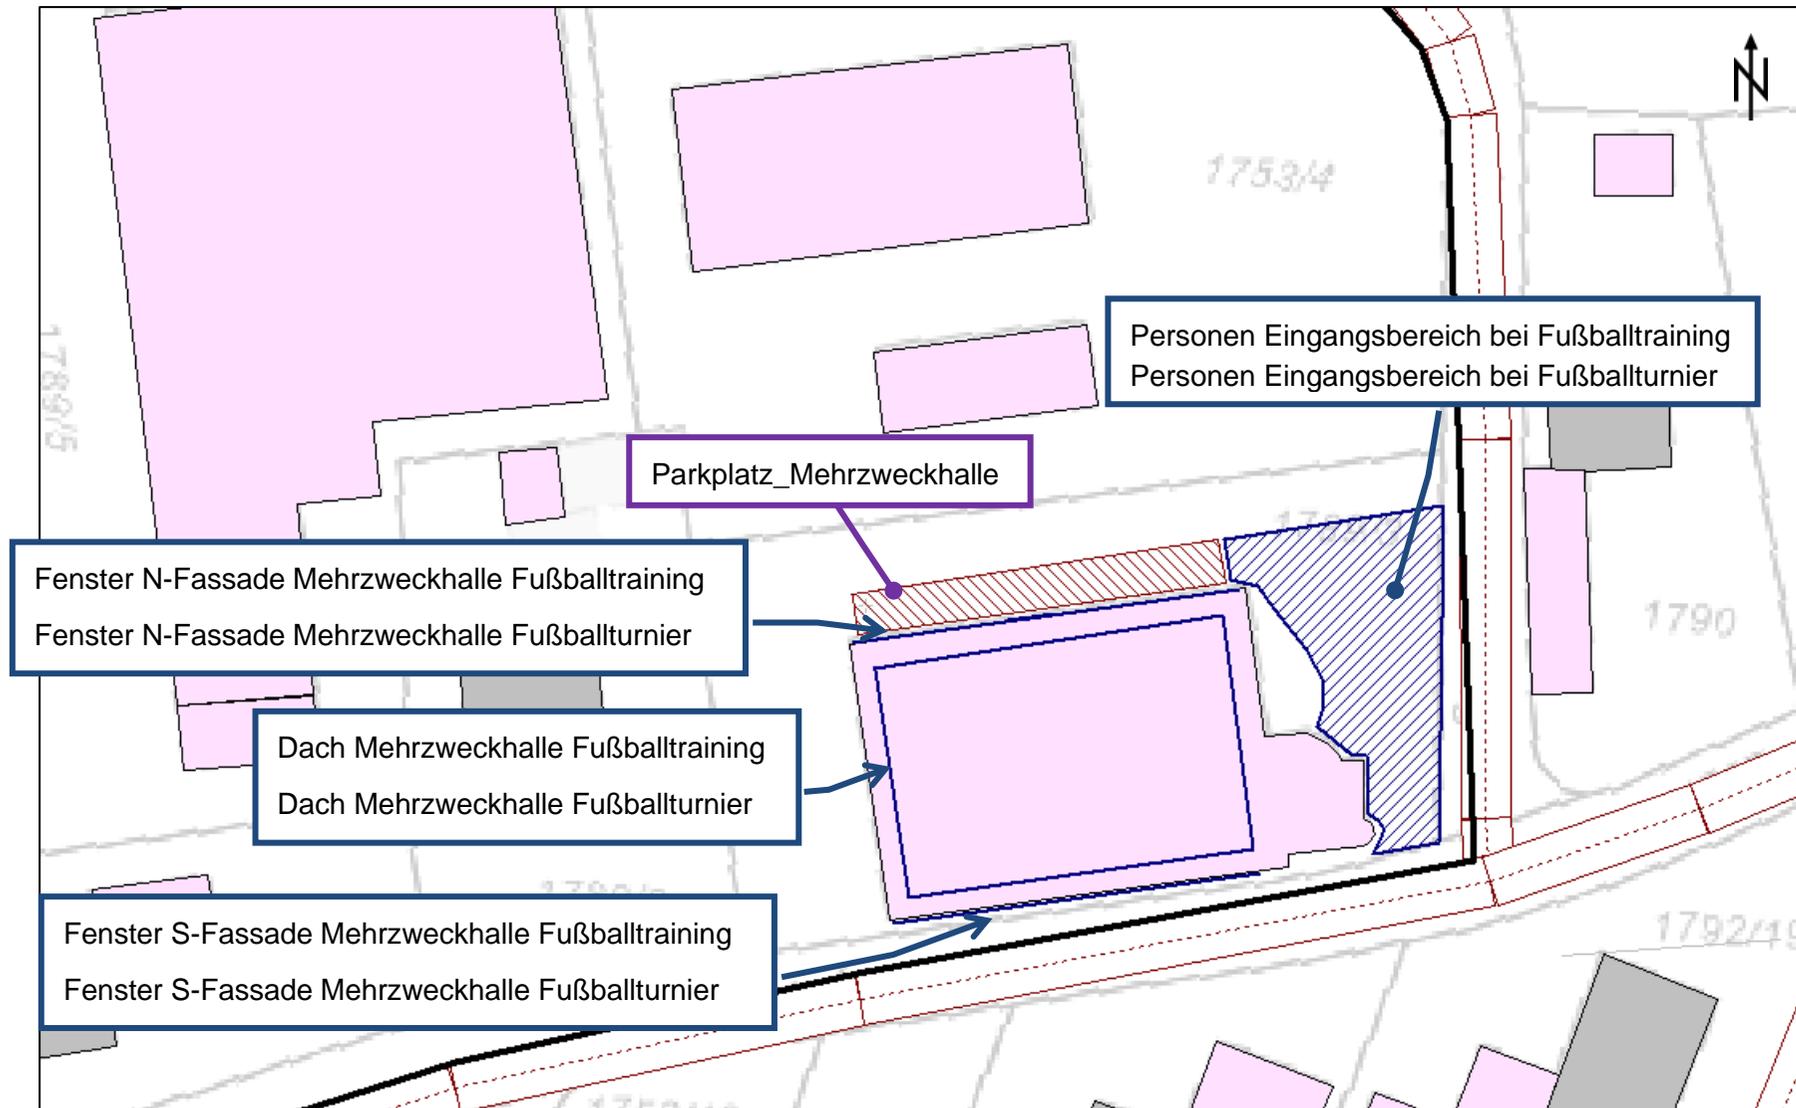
Lageplan mit Schallquellen Mehrweckhalle
